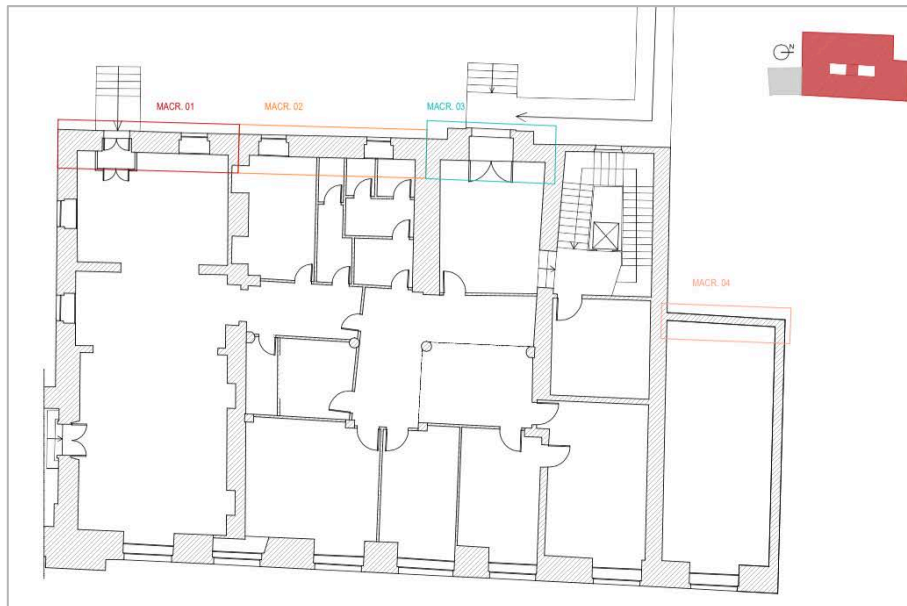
Individuazione in pianta dei macroelementi _ prospetto ovest
